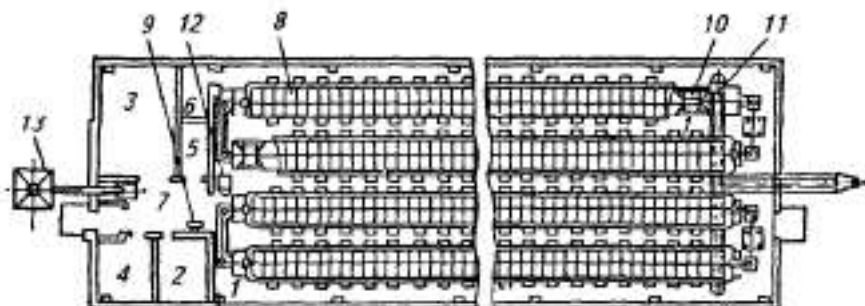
План крольчатника на 1104 клетки: 1 – помещение для содержания кроликов; 2 – служебно-бытовое помещение; 3 – вентиляционная камера; 4 – помещение для инвентаря и подстилки; 5 – помещение для кормов; 6 – электропитовая; 7 – коридор; 8 – батарея клеточная ОКФ-1-01.000; 9 – тележка для перевозки кроликов ОКФ-1-03.000; 10 – механизм пометный скребковый МПС-4М; 11 – транспортер скребковый КНЦ-7-12; 12 – тележка для перевозки кормов БЦМ-90-10А; 13 – бункер
